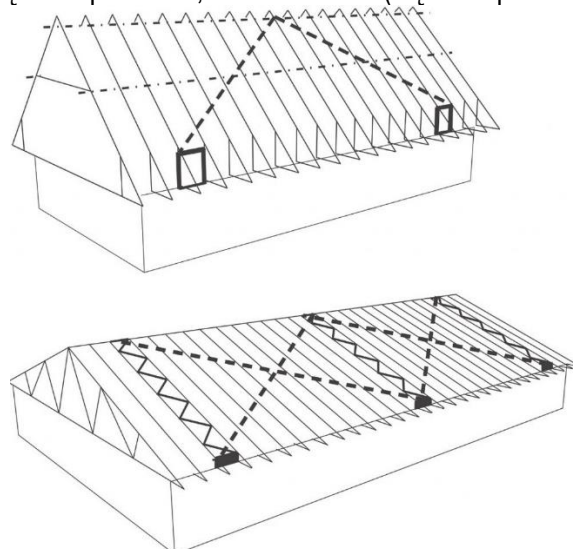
Połączenia elementów drewnianych więźby dachowej.
